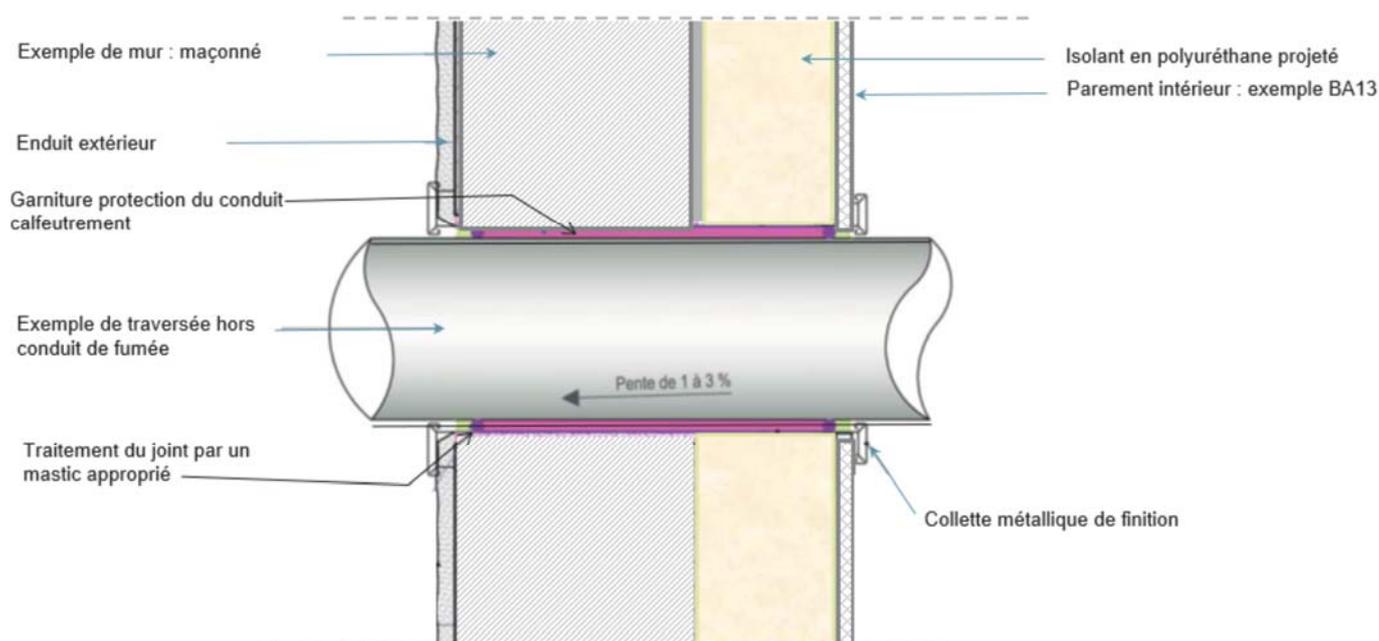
Traitement d'éléments traversants (autres que conduits de fumée)
